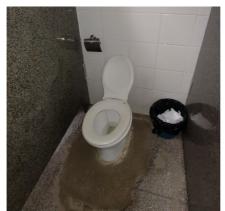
Outro caso de intervenção nas instalações sanitárias.
